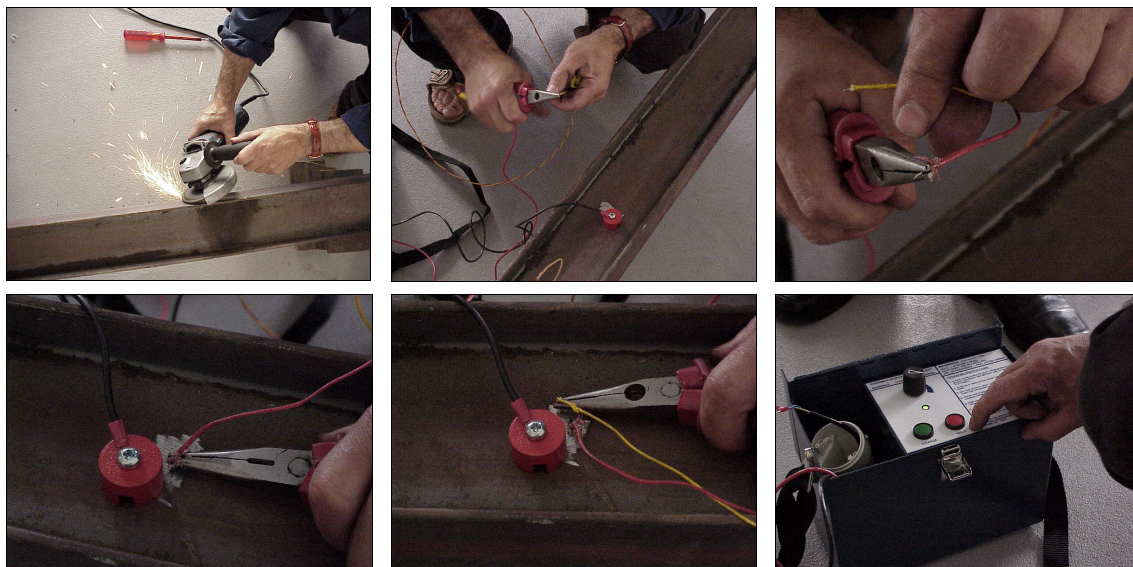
Colocação dos termopares e preparação da ligação à viga em teste.
